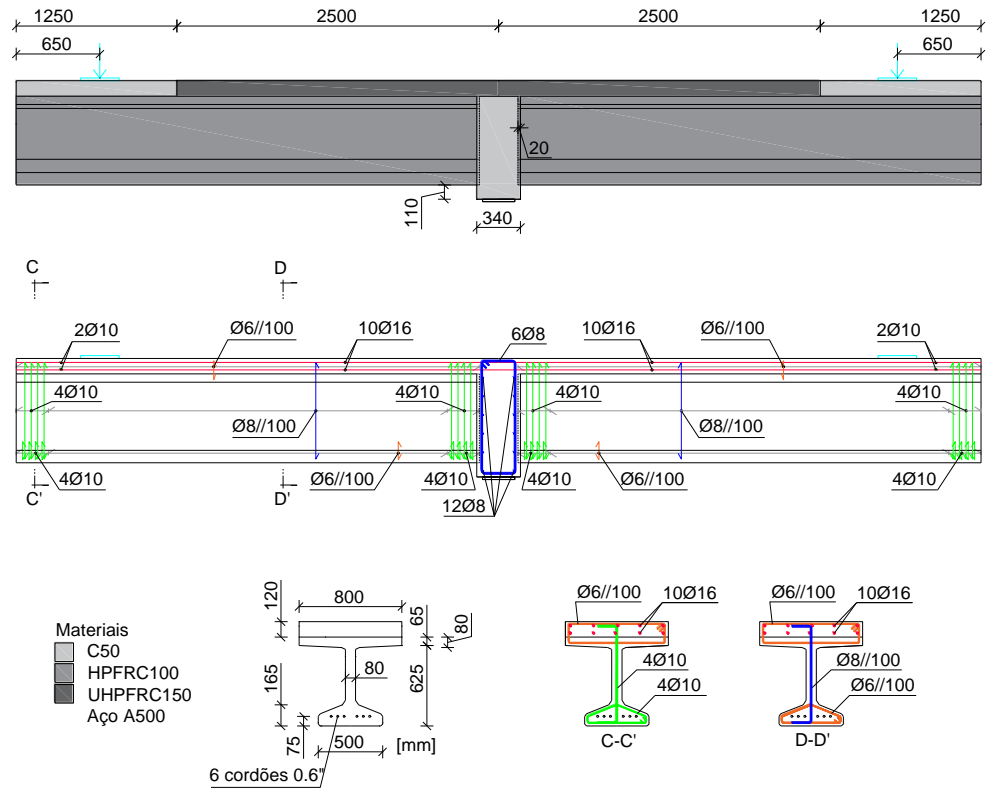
Modelo V2 – Vigas em HPFRC e laje em UHPFRC.
